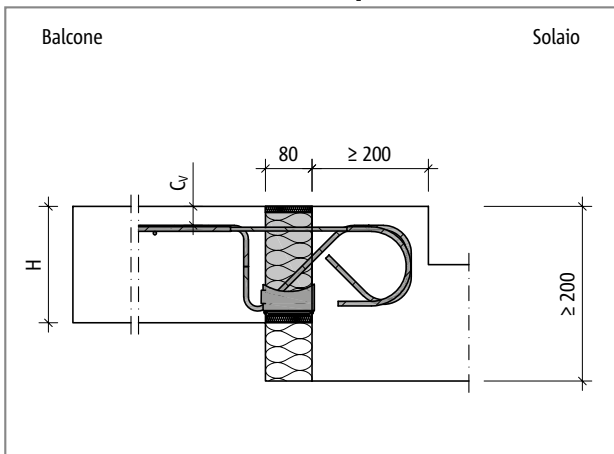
Schöck Isokorb® T tipo KL-O-M1 – KL-O-M7: balcone con innalzamento e isolamento esterno
